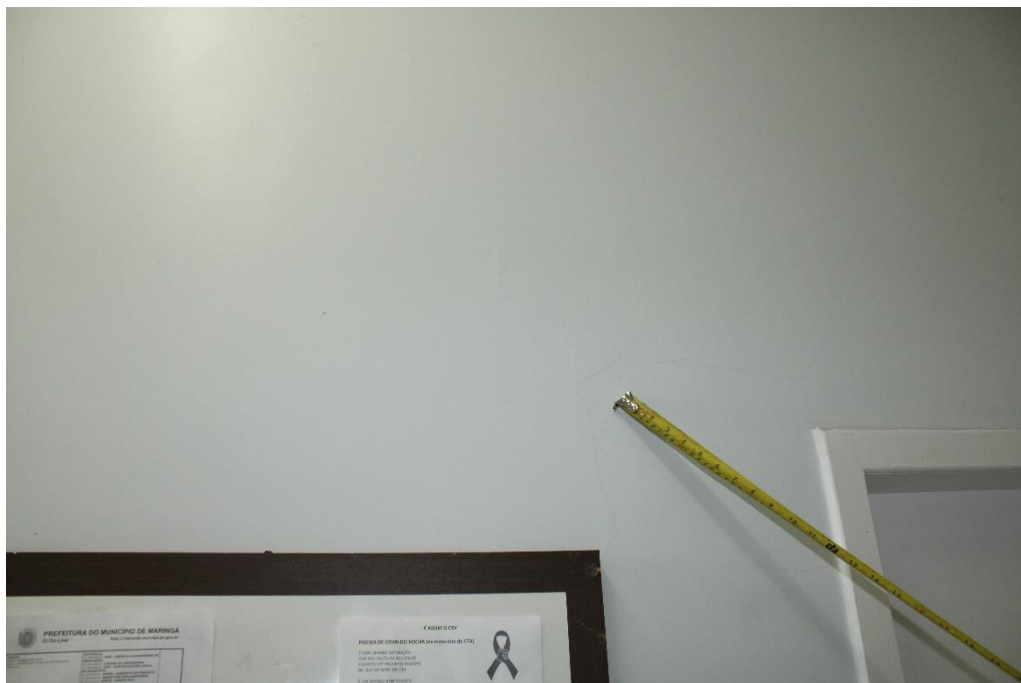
Em detalhe a Foto supra, destacando fissura em alvenaria.
